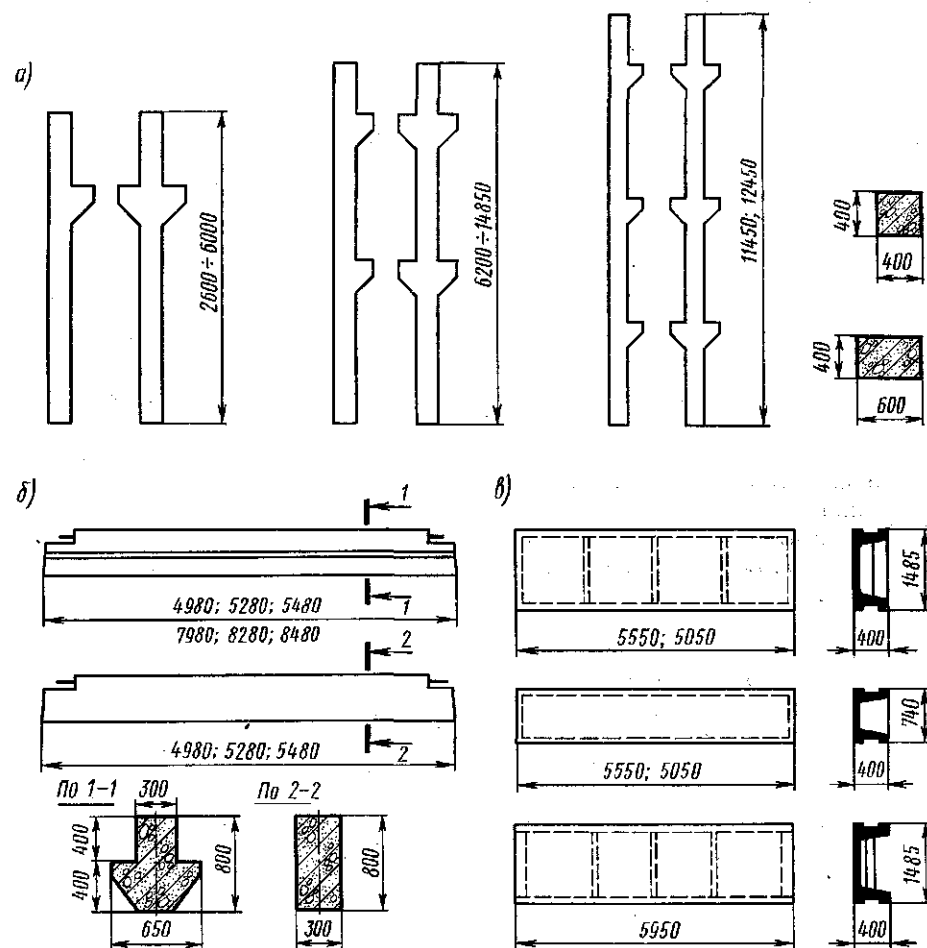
Элементы балочного железобетонного каркаса при опирании ригелей на консоли колонн:
